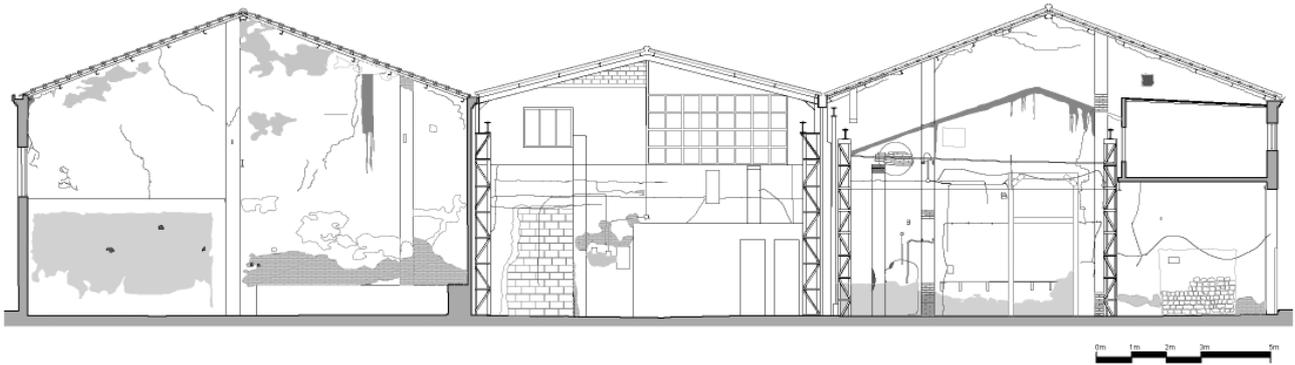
Plano de patologías del alzado interior norte de la Fábrica del Hielo
